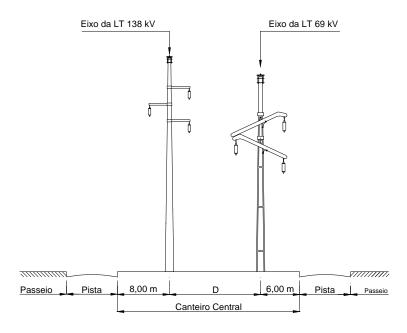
Canteiro central para duas LT's (69 kV e 138 kV)
